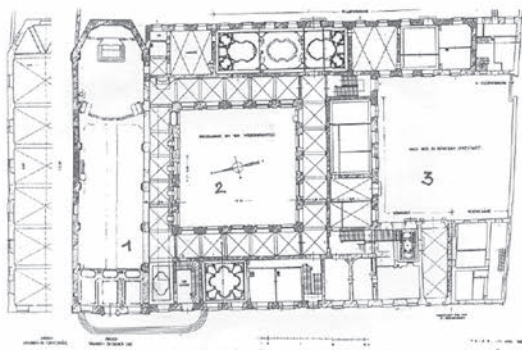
План 1-го этажа бывшего монастыря Св. Германа, 1938 г.
